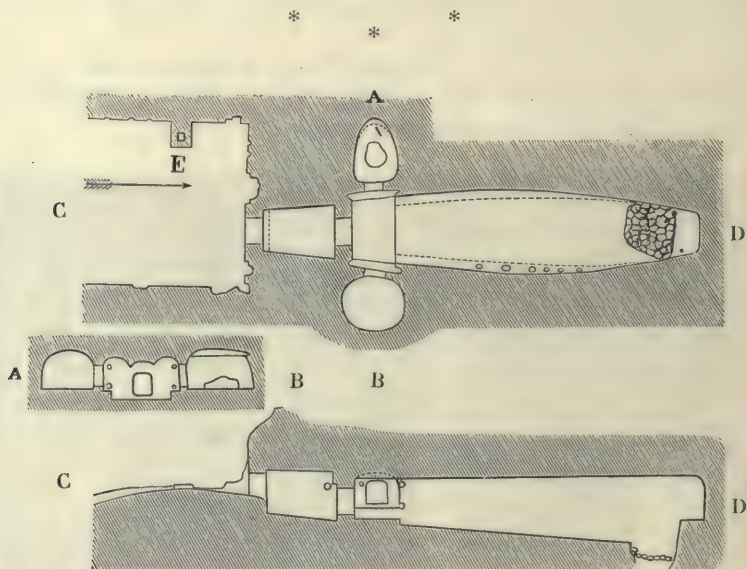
a—c. Grabkammer mit kurzem Gang. Grundriss und Durchschnitt.
